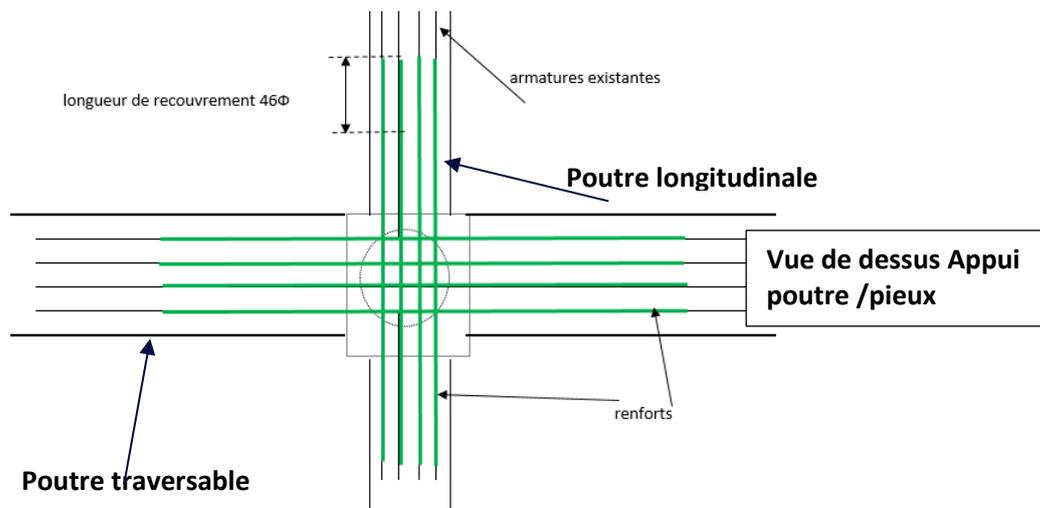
Principe d'implantation des barres au droit des appuis poutre/pieux
